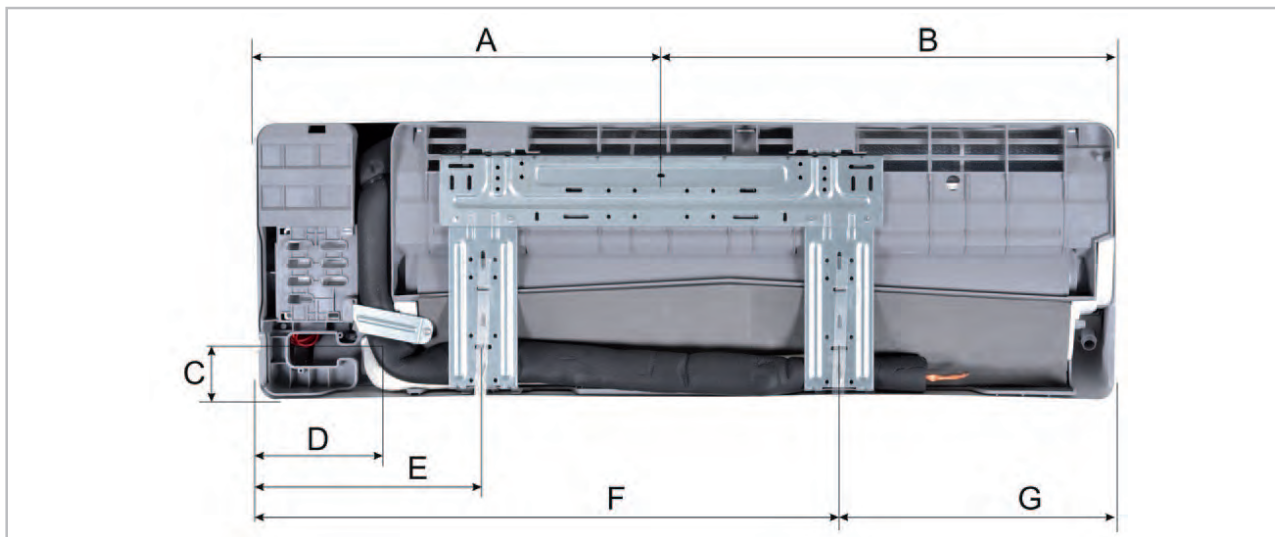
Montagepunkte der Wandhalterung MVW 362-562 (alle Maße in mm)
